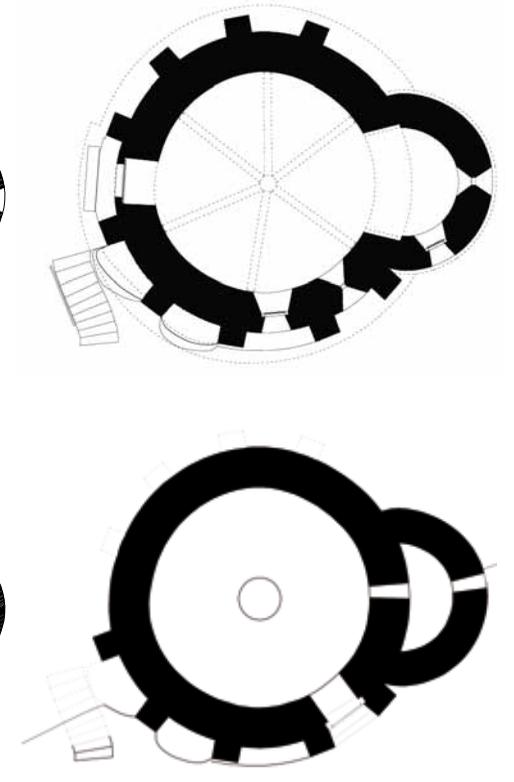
Grundrisse Berg, M 1:200. TU Graz/Wildpaner 2009.
